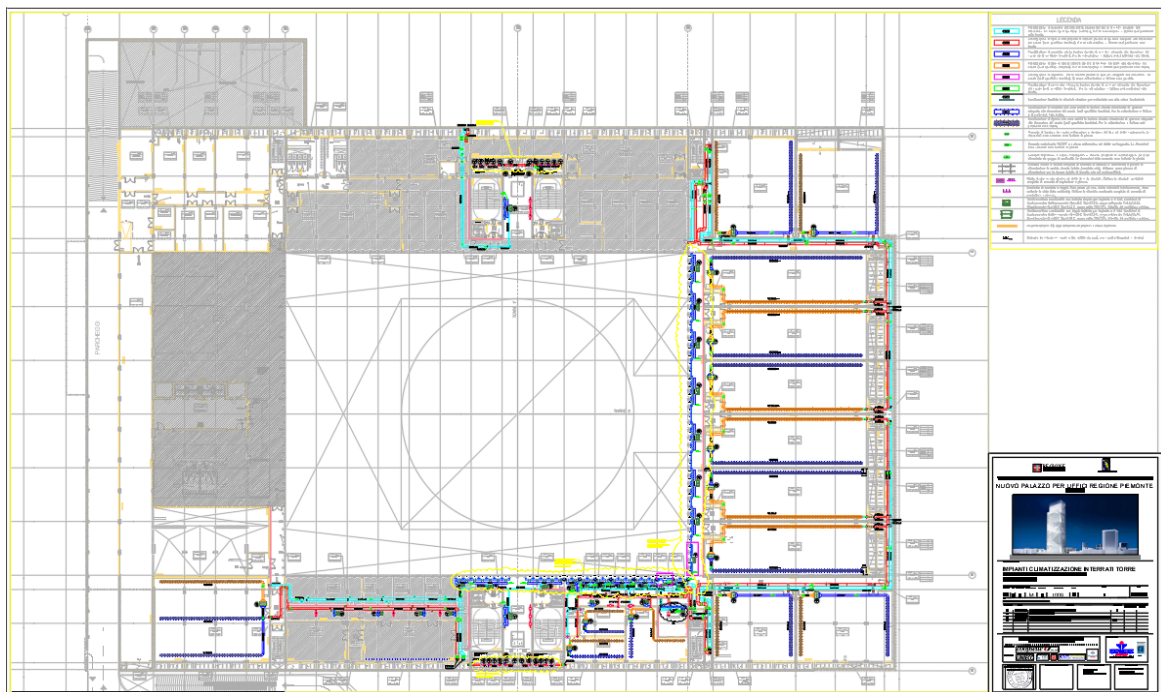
Pianta livello -1 Distribuzione Aria, Impianti Climatizzazione Interrati Torre
